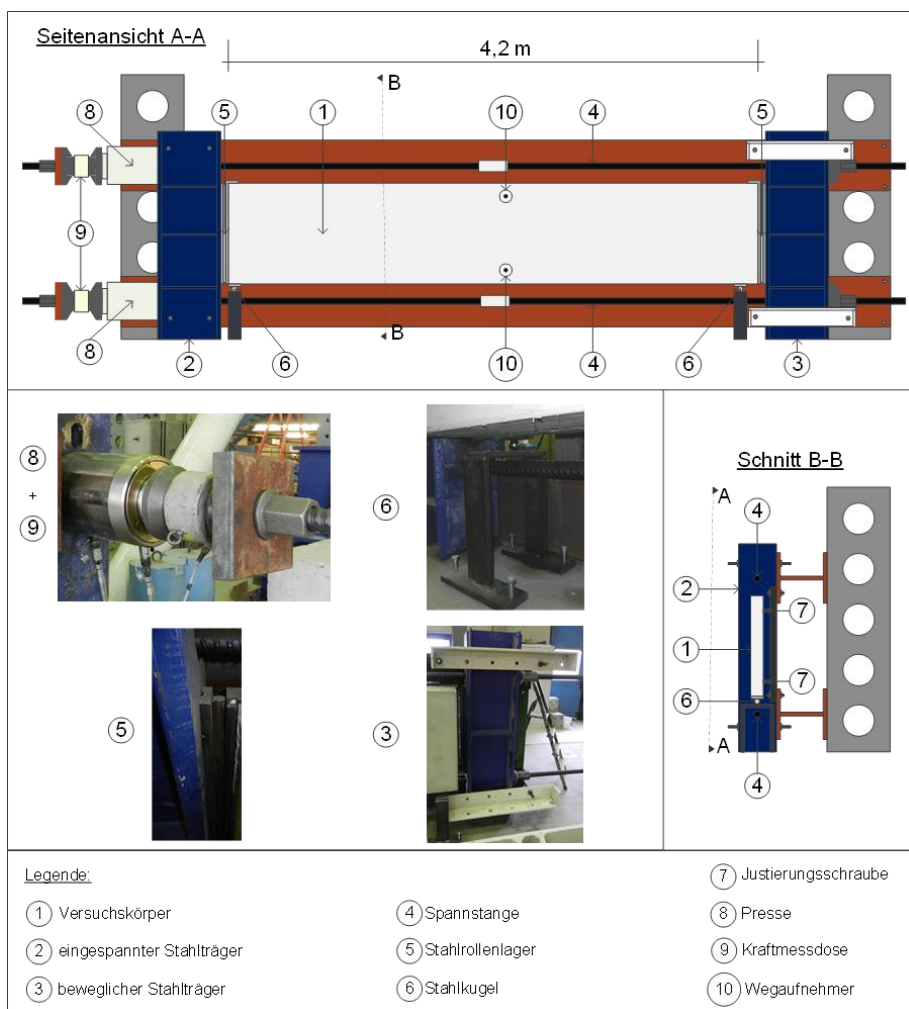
Versuchsaufbau und Messtechnik für die Druckversuche an Stahlbeton- und an Sandwichwänden (Darstellung mit Stahlbetonwand)
